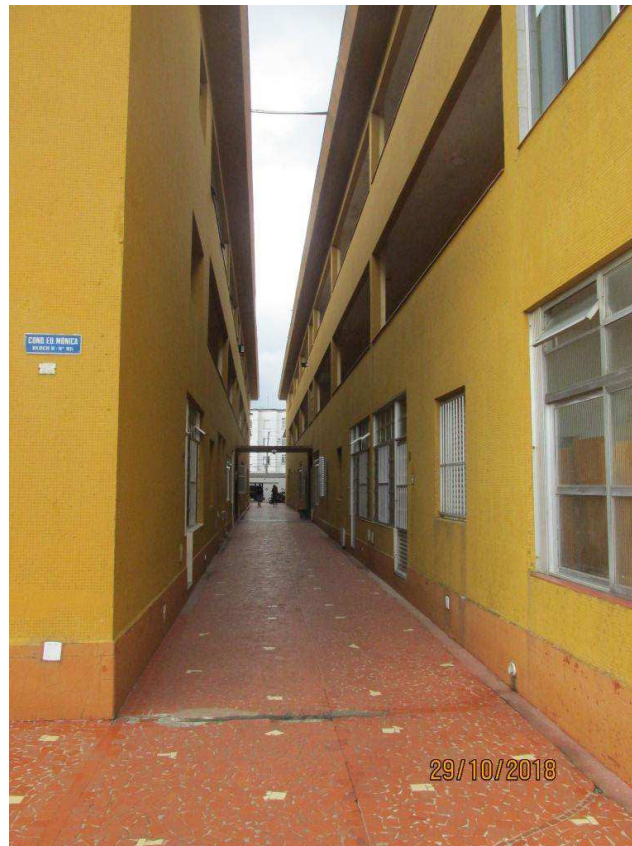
Detalhes da circulação interna (área comum), com piso danificado
